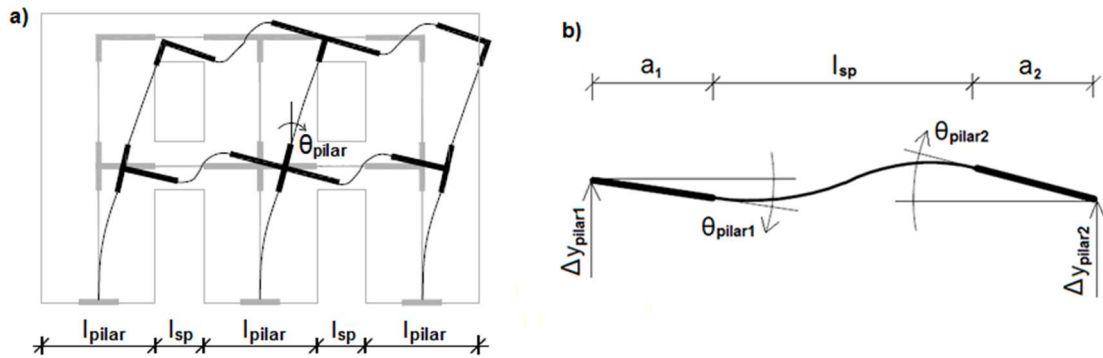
a) Deformación de pórtico equivalente sujeto a cargas laterales; b) Deformación de viga-dintel en función de las demandas de desplazamiento de los pilares adyacentes (adaptado de Beyer y Dazio, 2012)
